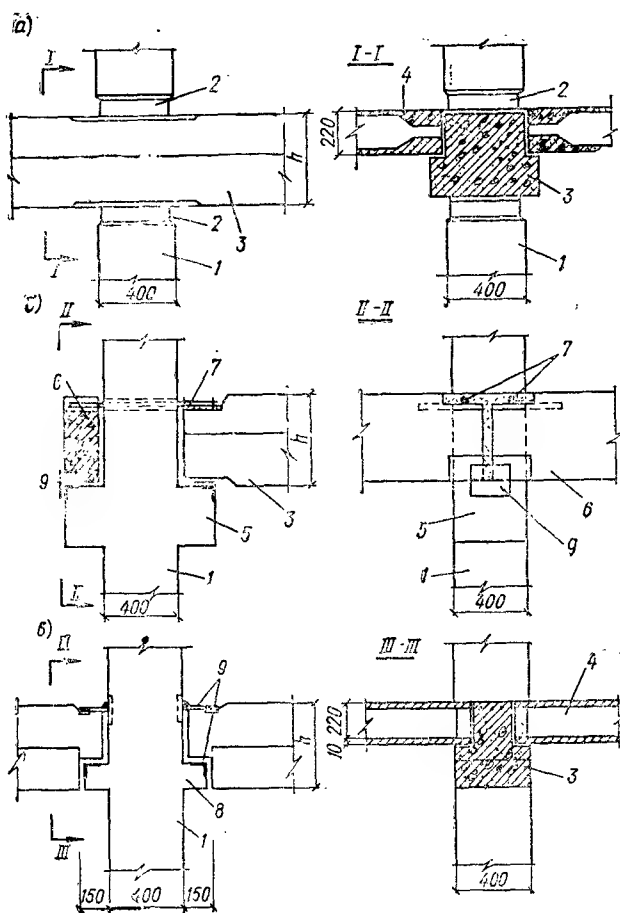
Железобетонные ригели, обвязочные балки и их стыки с колоннами
